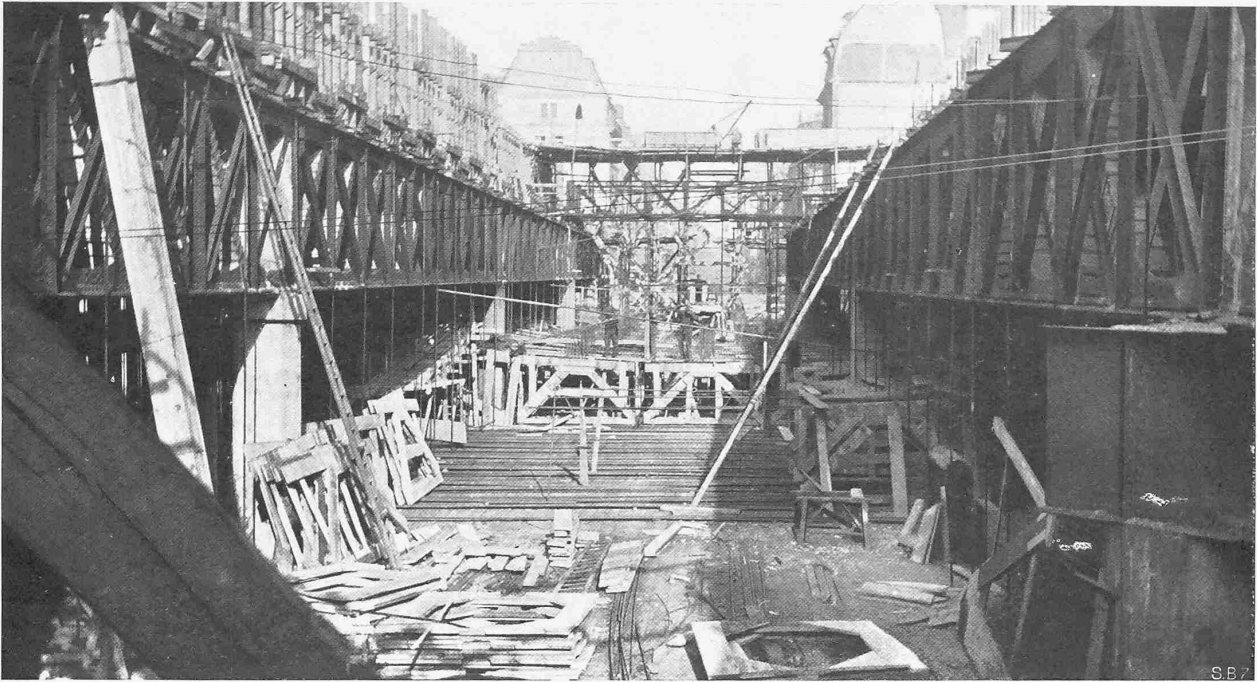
Vue intérieure du chantier. Construction des entretoises sur le plancher de travail suspendu aux anciennes poutres métalliques.
